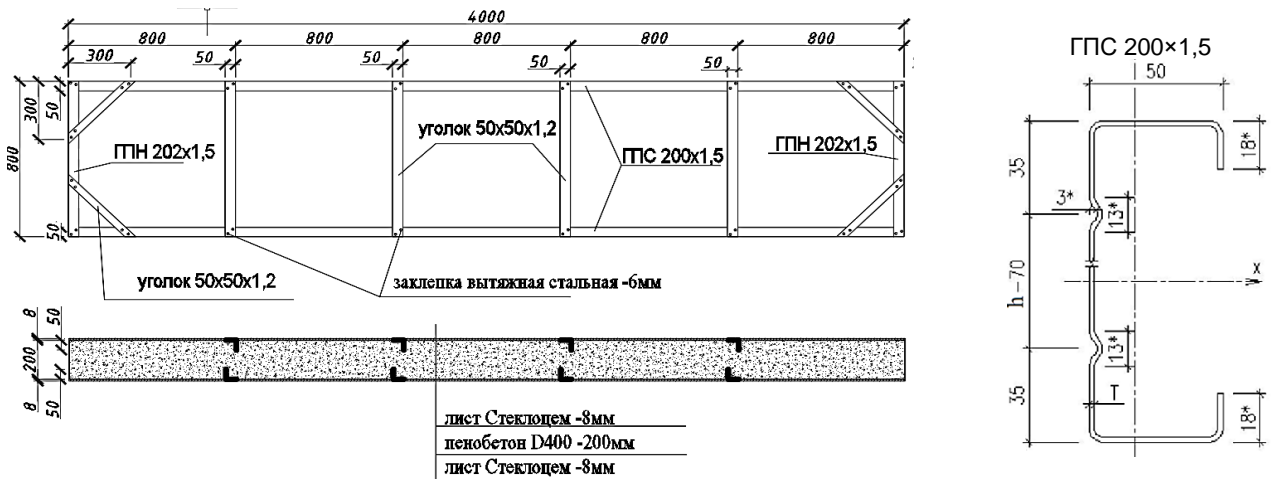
Конструкция панели перекрытия для испытания на изгиб
